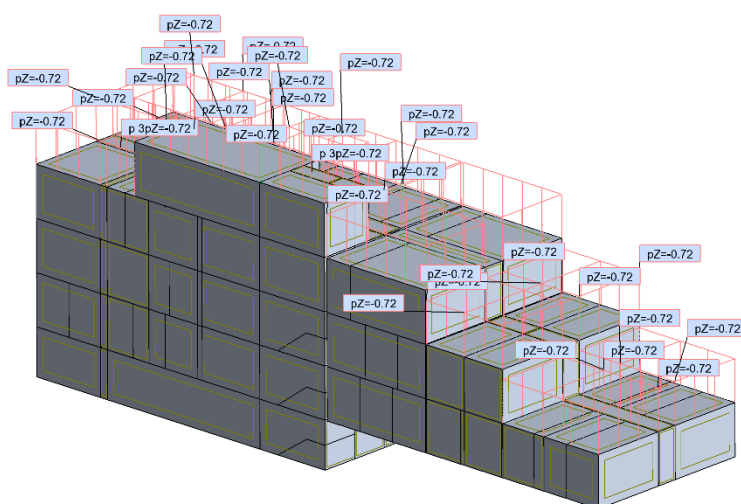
Przypadek obciążenia użytkowego 1 dachu technicznego
